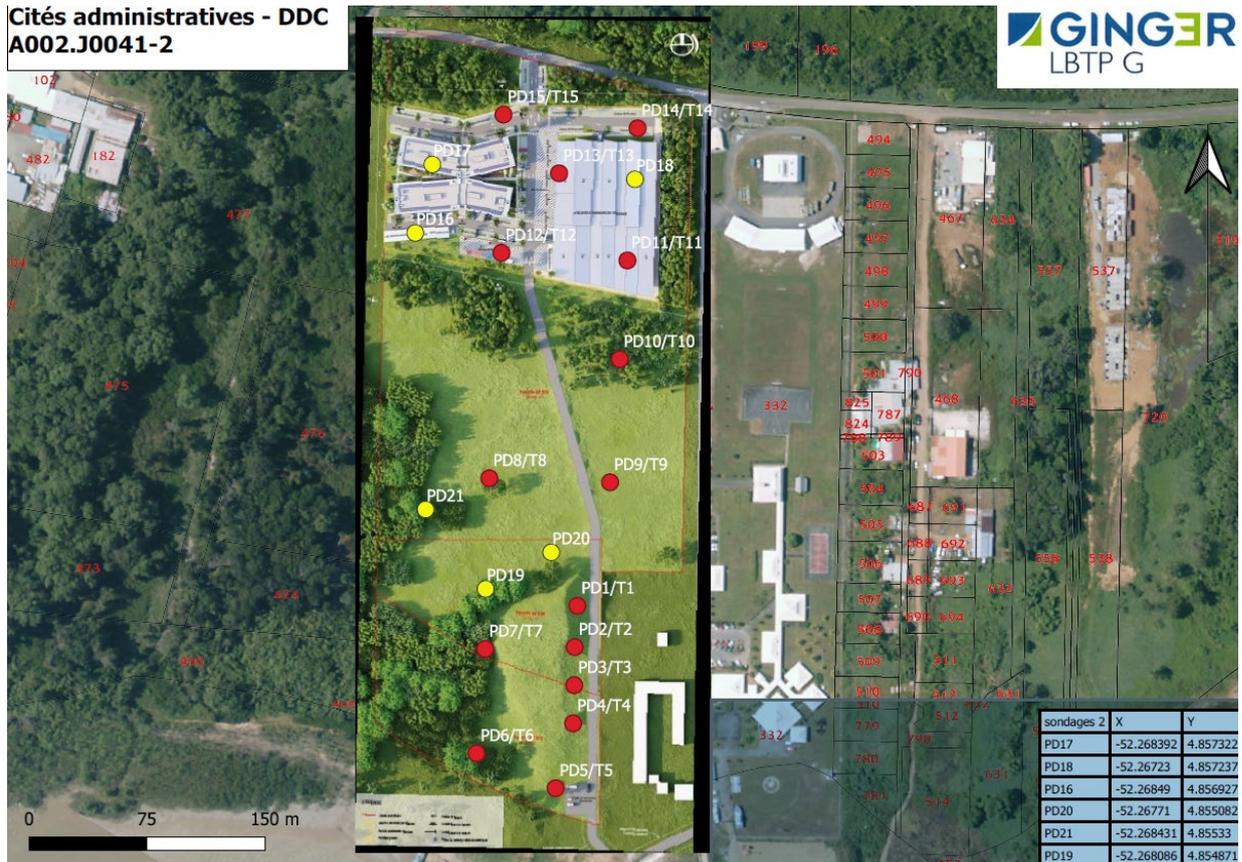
Plan d'implantation des sondages géotechniques, mission G2
